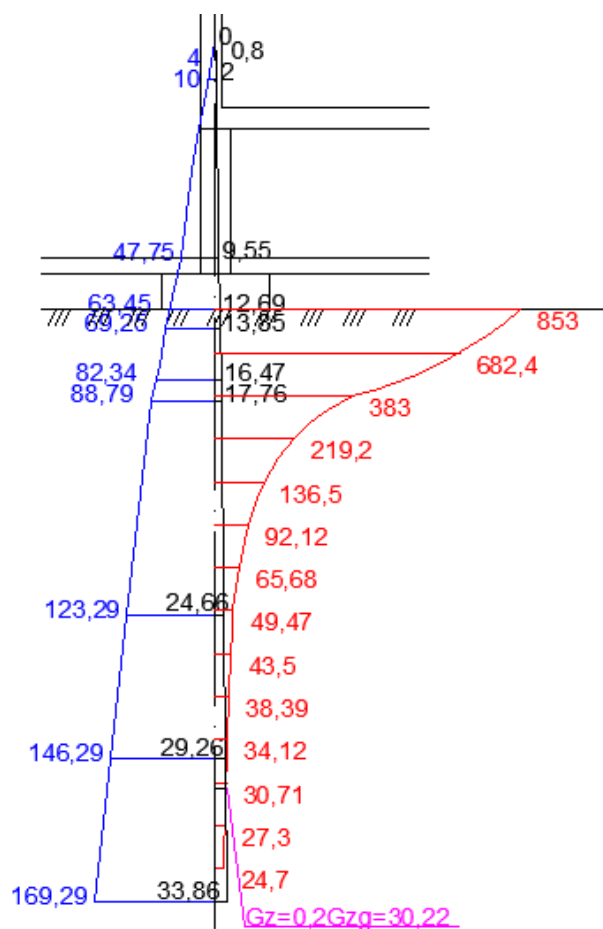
Определение осадок фундамента на естественном основании под колонну
